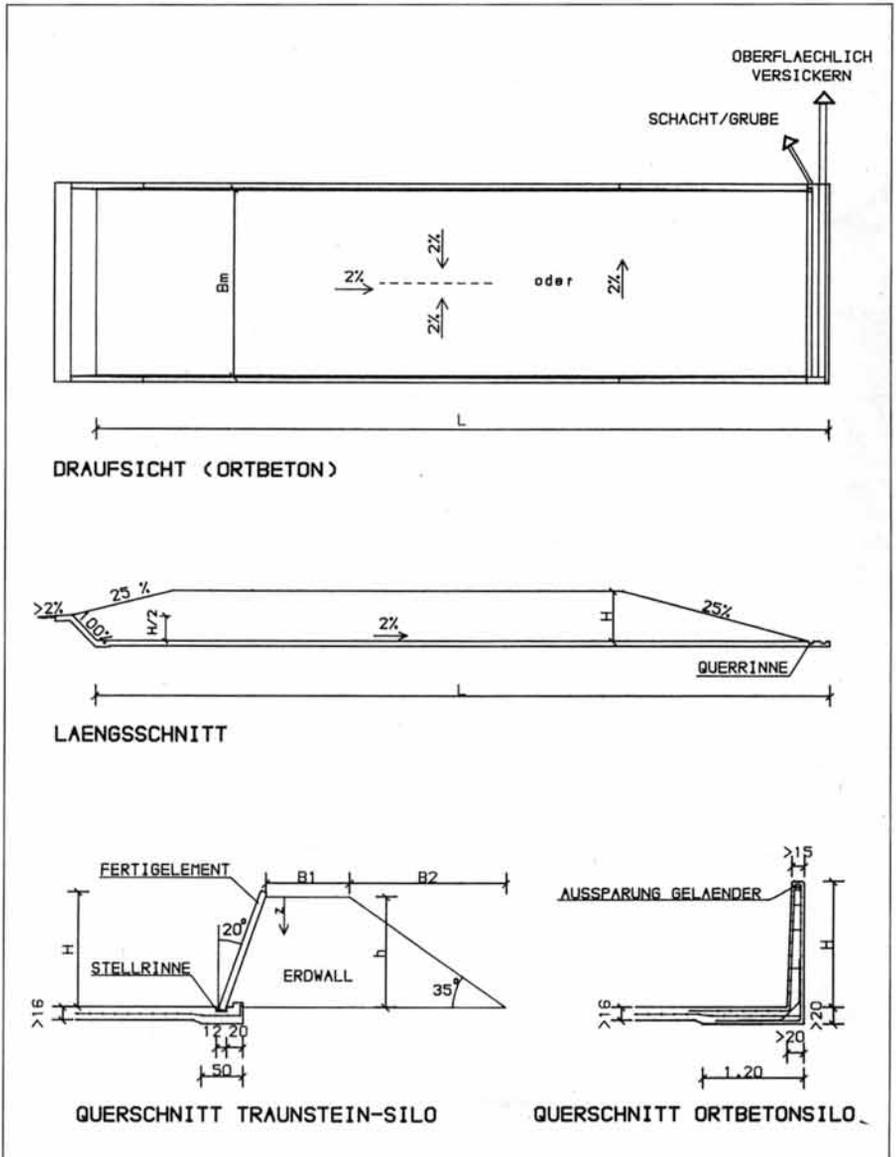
Grundriss, Querschnitt und Längsschnitt eines Traunstein-Silos und eines Ortbetonflachsilos.
